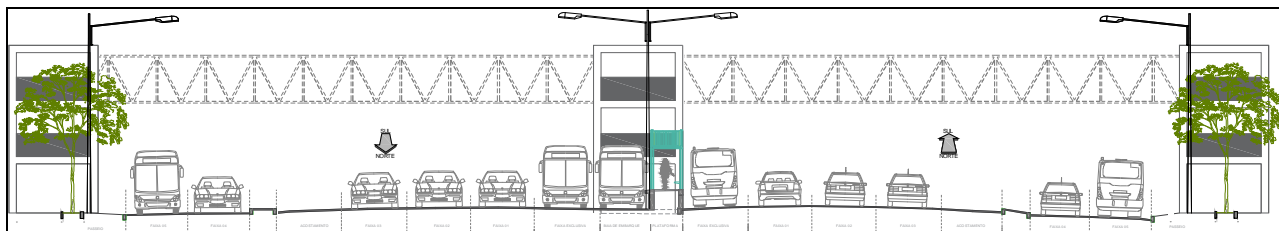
Corte Esquemático Proposto da BR 116 - Fonte: SEINF
